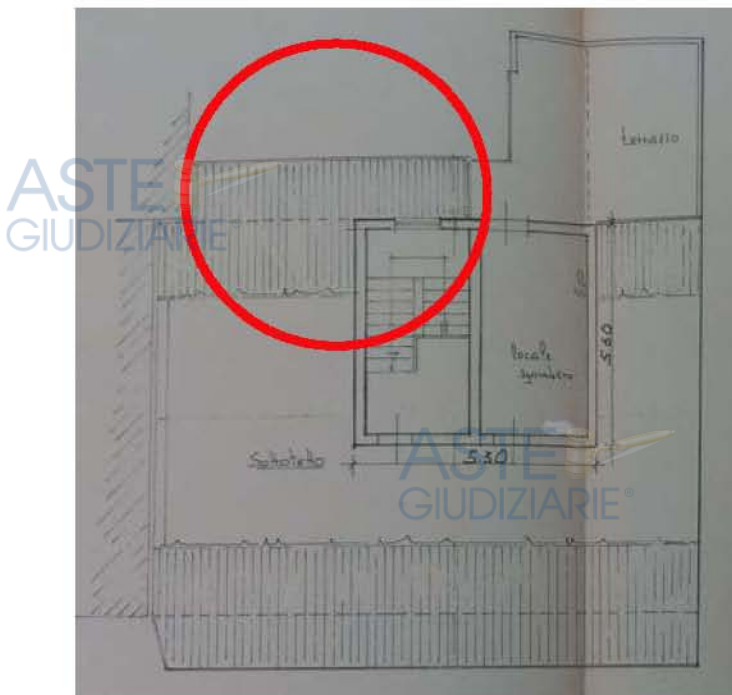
Rappresentazione del prospetto del tetto lato Ovest come da Concessione
